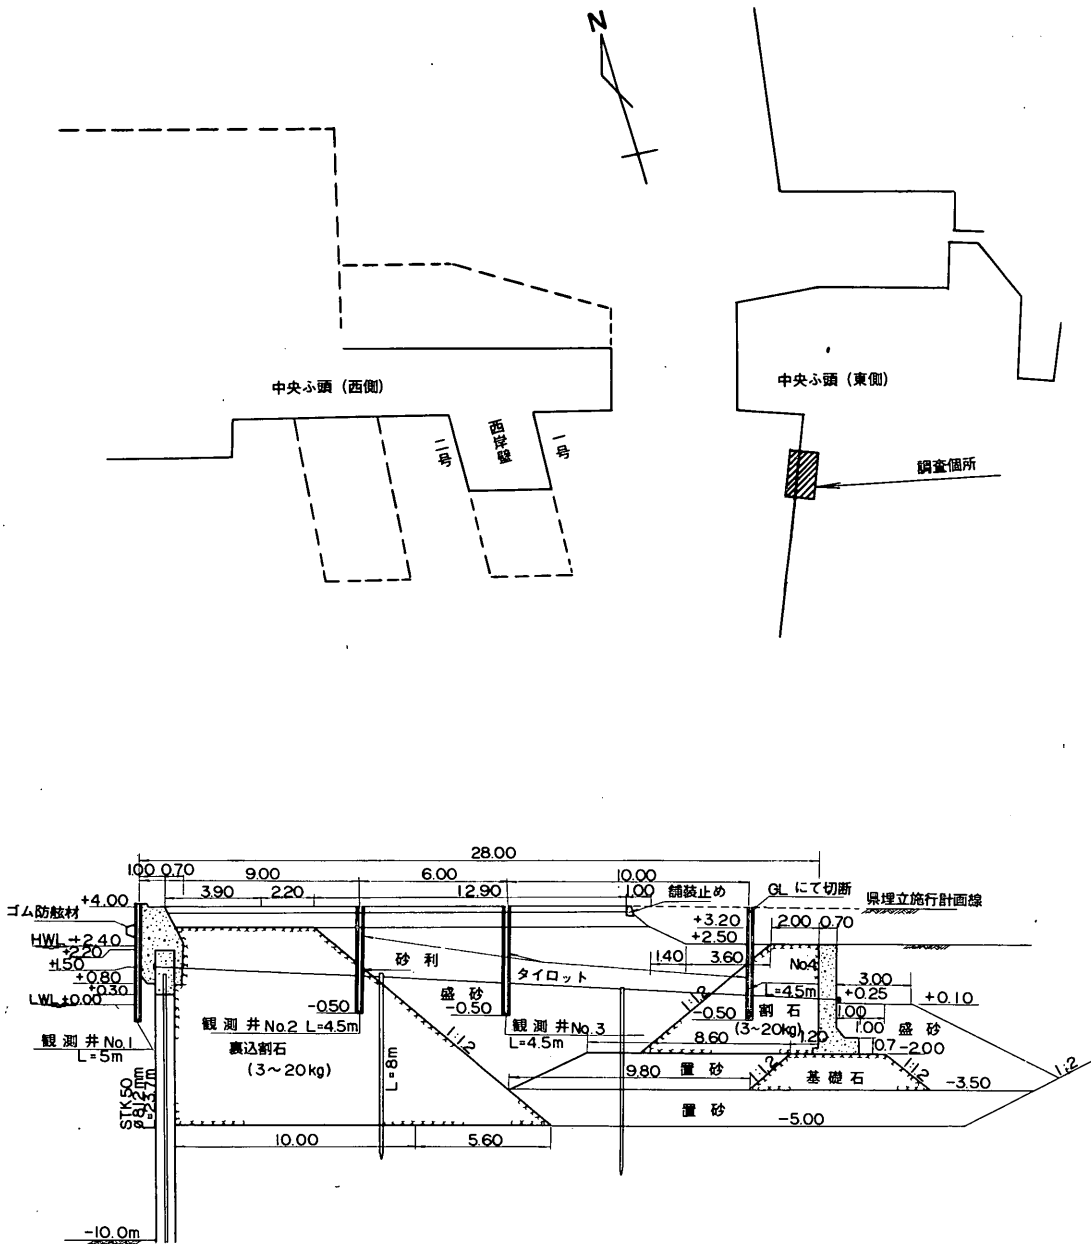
32 衣浦港平面図および中央ふ頭東 - 9 M 岸壁断面図
